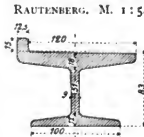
Straßenschienen für Fahrverkehr nach RAUTENBERG. M. 1 : 5.
